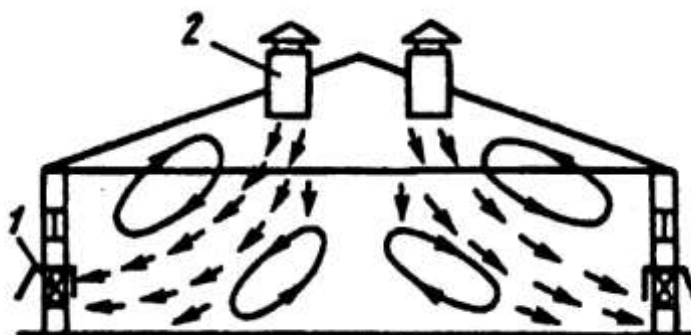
Вытяжная вентиляция с настенными вентиляторами: 1 - настенные вентиляторы; 2 - приточные шахты.
